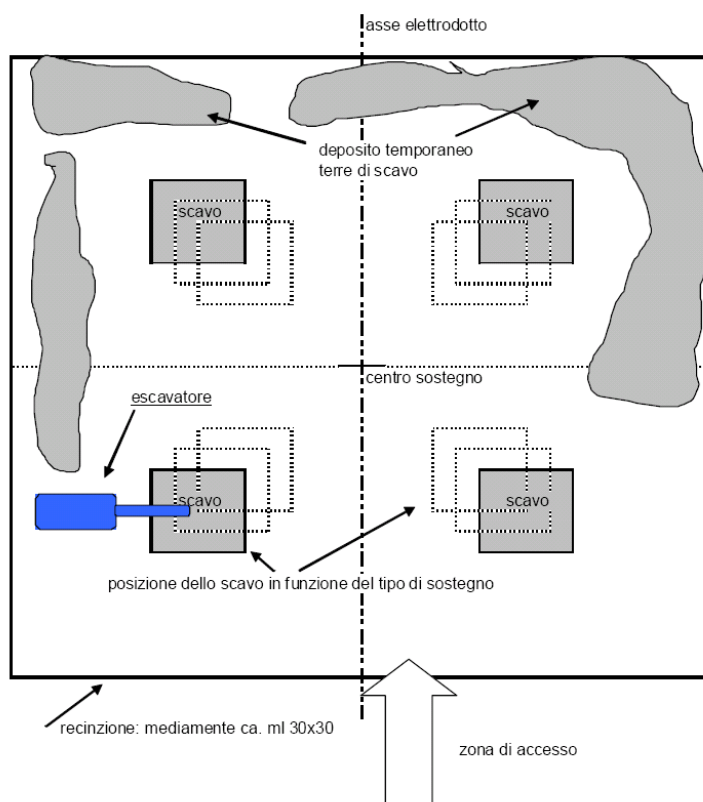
Planimetria dell'area di sostegno (scavo di fondazione)
